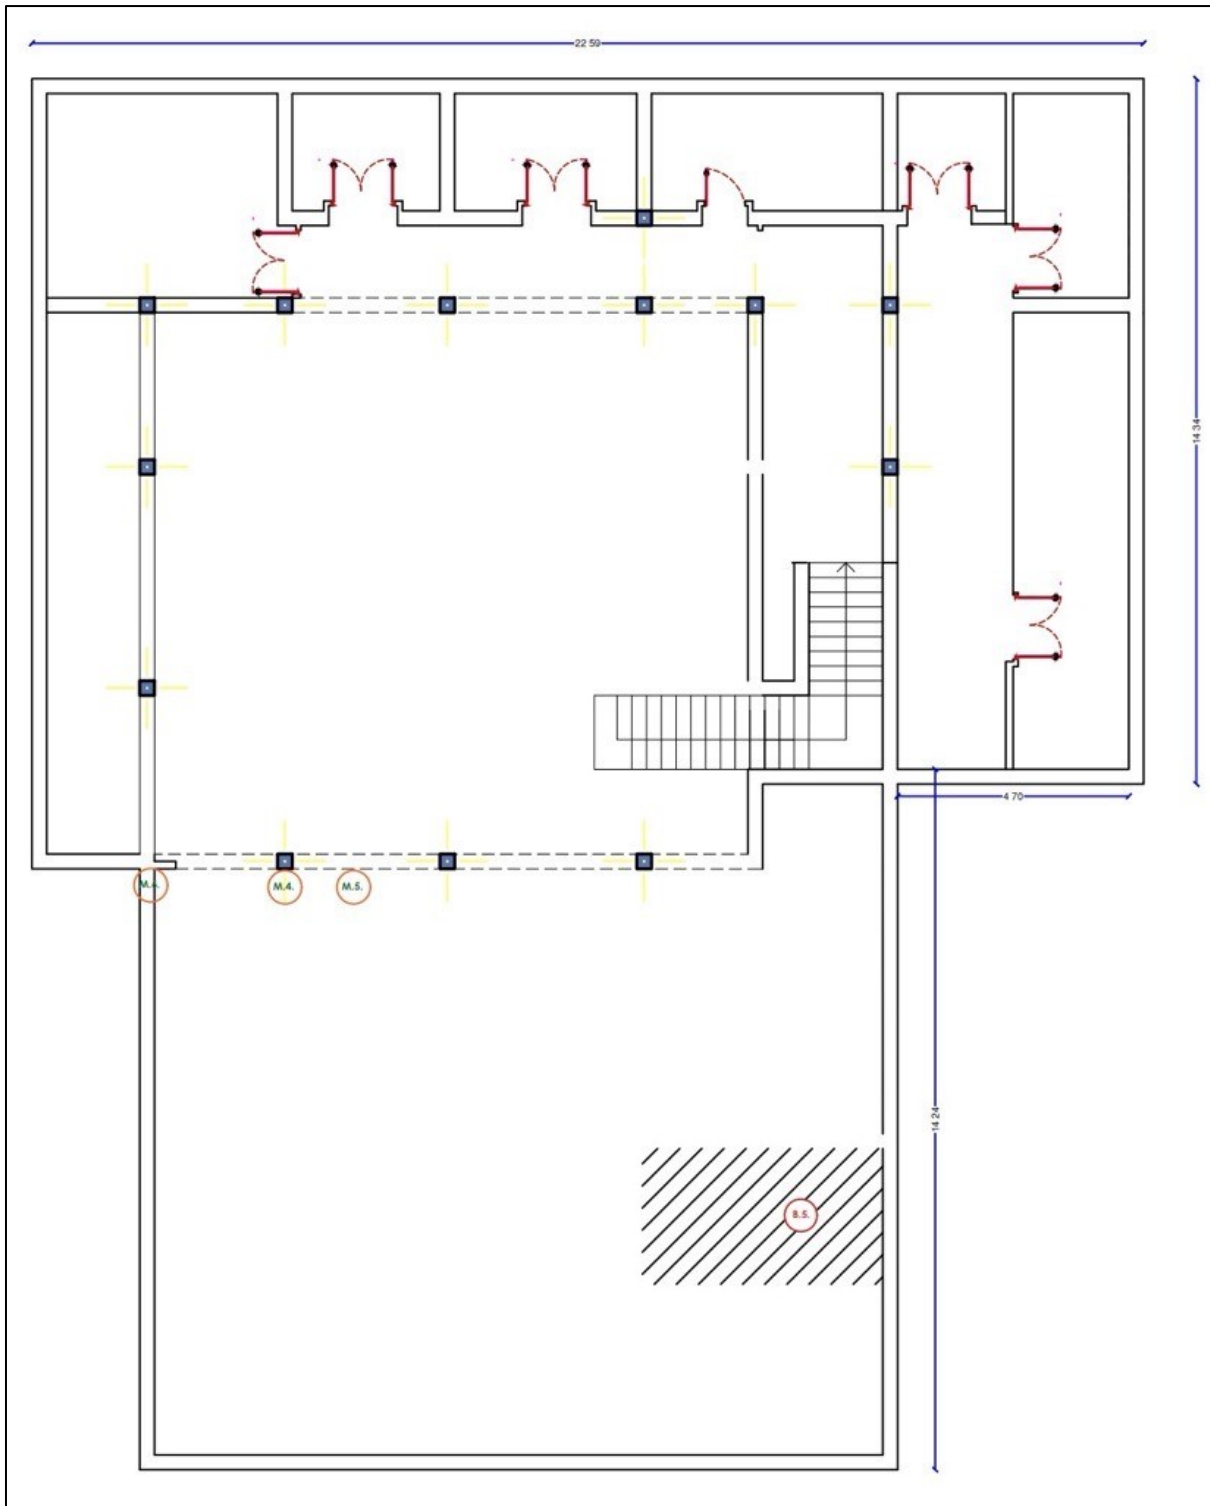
Plan des dégradations au niveau de l'étage courant
